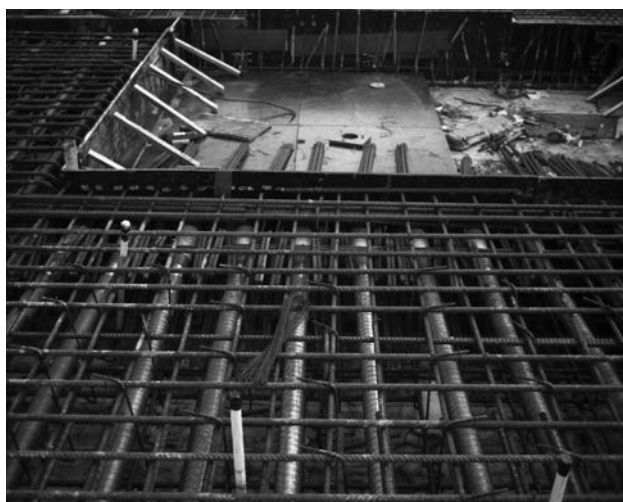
Detalle de anclajes activos de la losa en voladizo.
